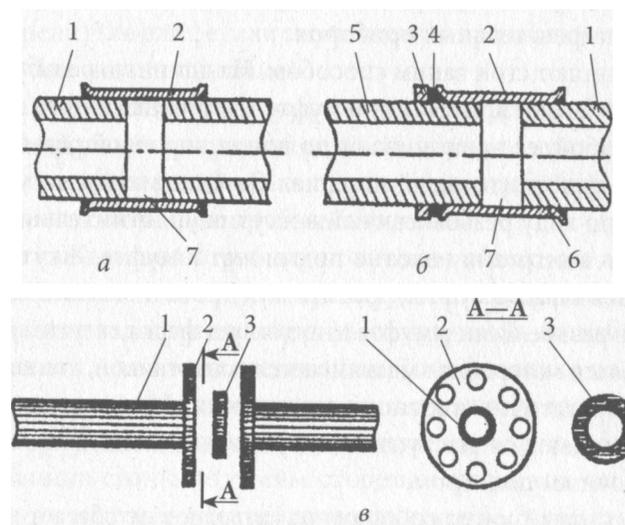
Соединение стальных труб: *а* — на короткой резьбе; *б* — на длинной резьбе: 1 — труба; 2 — муфта; 3 — контргайка; 4 — уплотнение; 5 — длинная резьба (сгон); 6 — короткая резьба; 7 — зазор между торцами труб; *в* — фланцевое соединение труб: 1 — труба; 2 — фланец; 3 — прокладка
